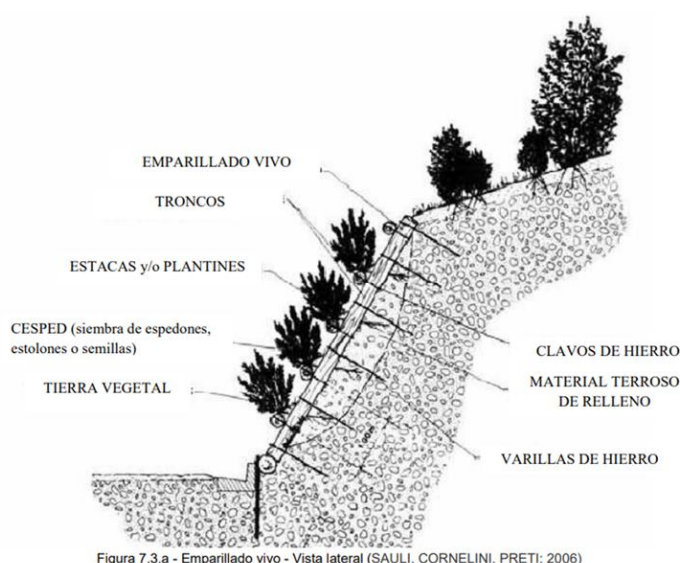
a - Emparillado vivo - Vista lateral (SAULI, CORNELINI, PRETI; 2006)
